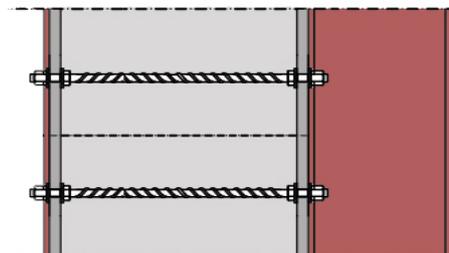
prospetto sistema di ancoraggio, SCALA 1:10.
